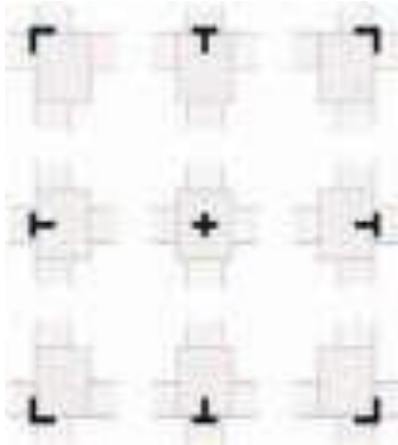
I filari fissi sono le facce di pareti o di pilastri che per tutta l'altezza di una struttura non hanno nessun cambiamento planimetrico.
